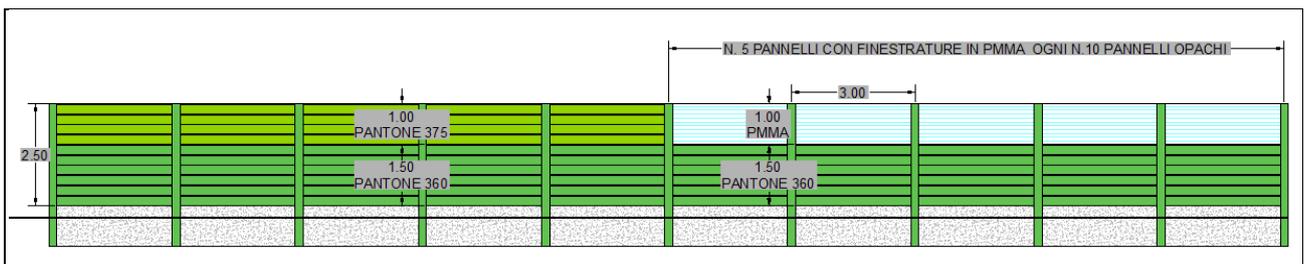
PROSPETTO TIPO BARRIERA ANTIRUMORE H 3,0 M CON PANNELLI IN PMMA DI DIMENSIONI 3X1 E 3X1,5 M CON ANDAMENTO SCALARE DIVENTANDO A TUTTA ALTEZZA
